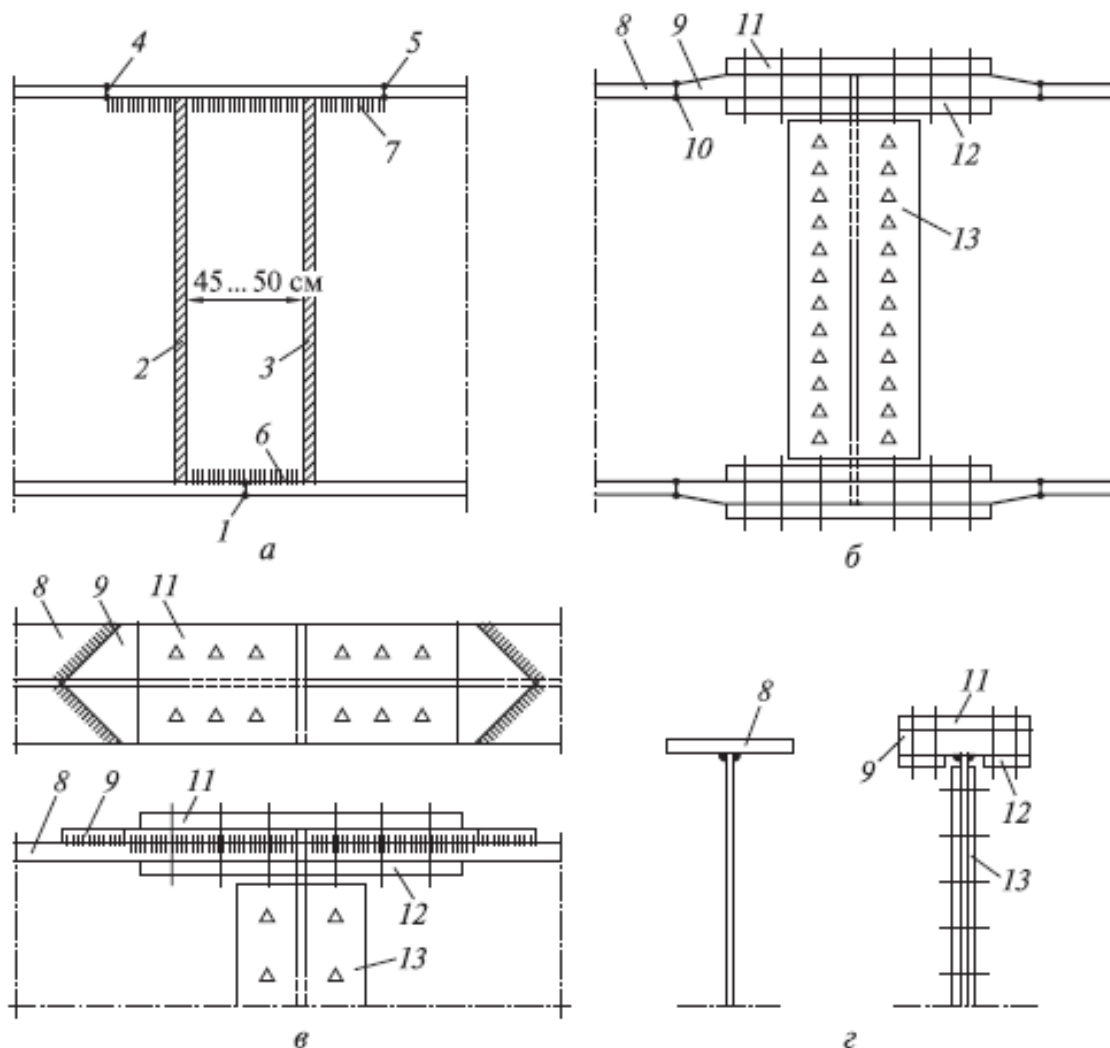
Сварные (а) и болтовые (б—в) монтажные стыки сварных балок:
